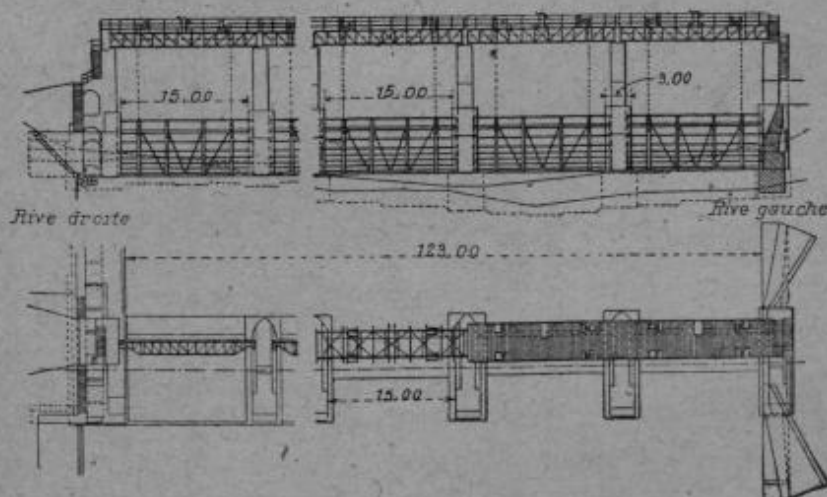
Élévation et plan partiels du barrage sur l'Aar.
